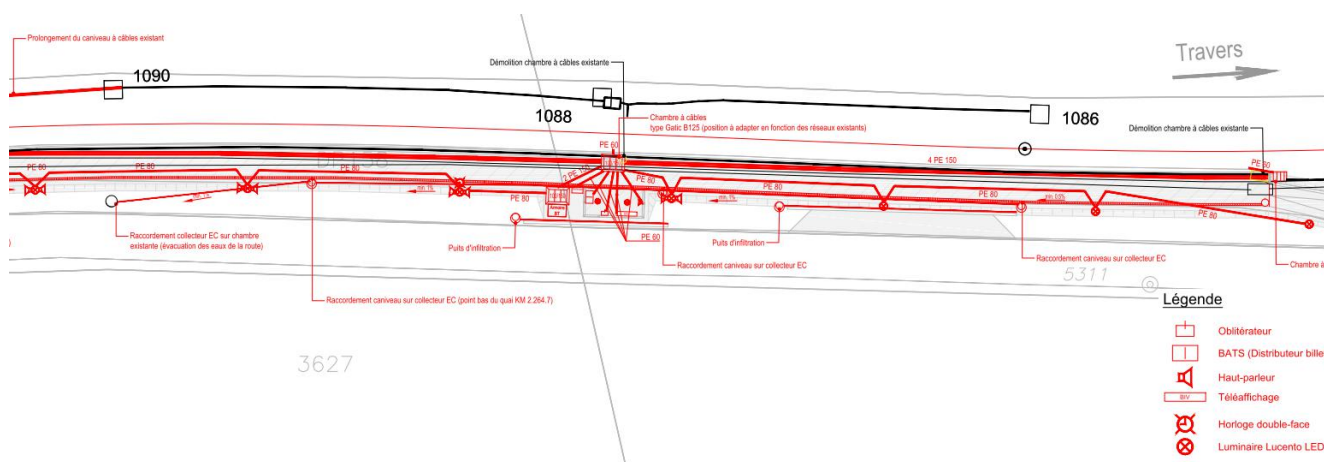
Extrait du plan de situation de la halte de La Presta [10]
